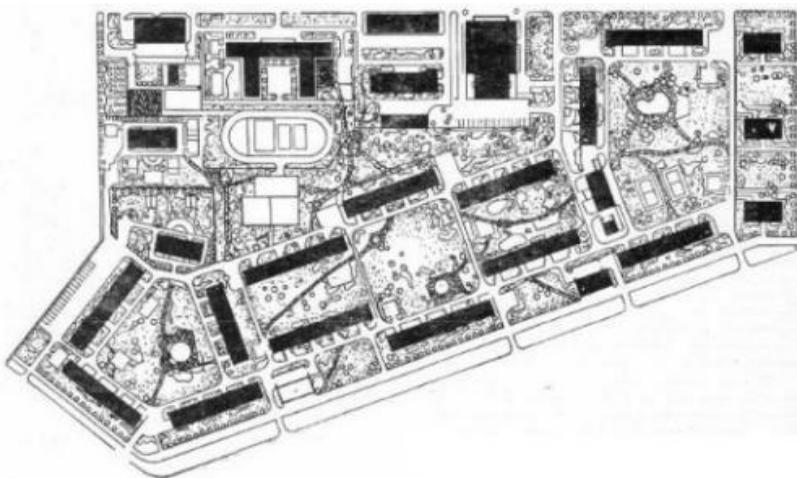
План жилой зоны 9-ого квартала Новых Черёмушек
